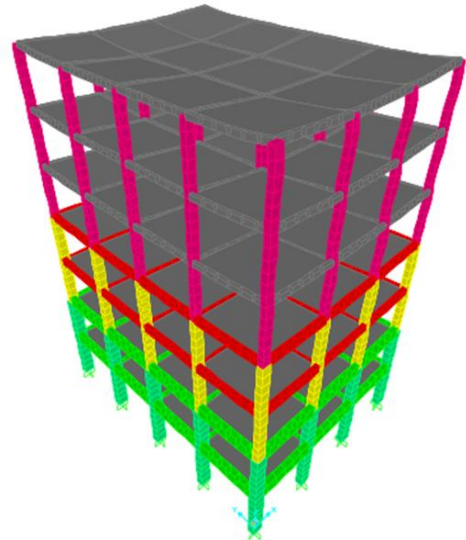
Model Struktur 3D Banguna Gedung Lantai 6
